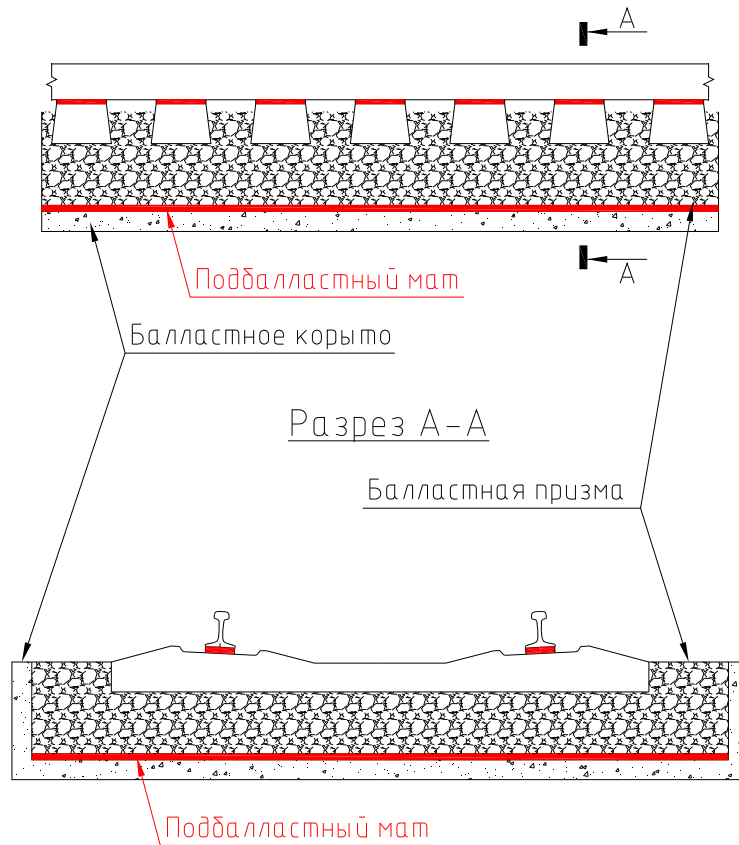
Тип 3. Железобетонные шпалы с упругими промежуточными креплениями. Балластная призма на подбалластном мате
